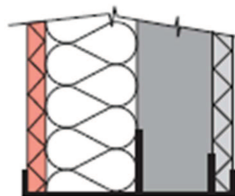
Monolitická betonová stěna s bedněním ze štěpkocementových desek [8]
